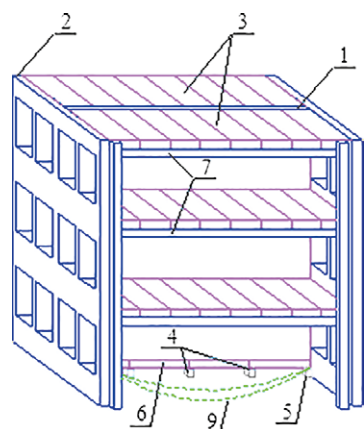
Схема модели: 1 – внутренняя стена; 2 – наружная стена;
